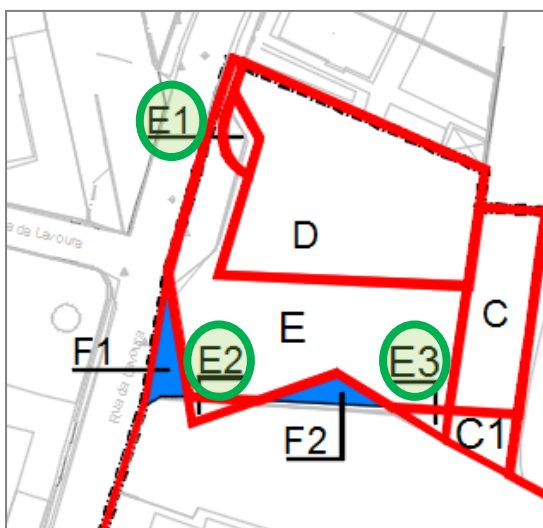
Limite da Unidade de Execução e do loteamento aprovado, com o desenho da Avenida até ao Mar
